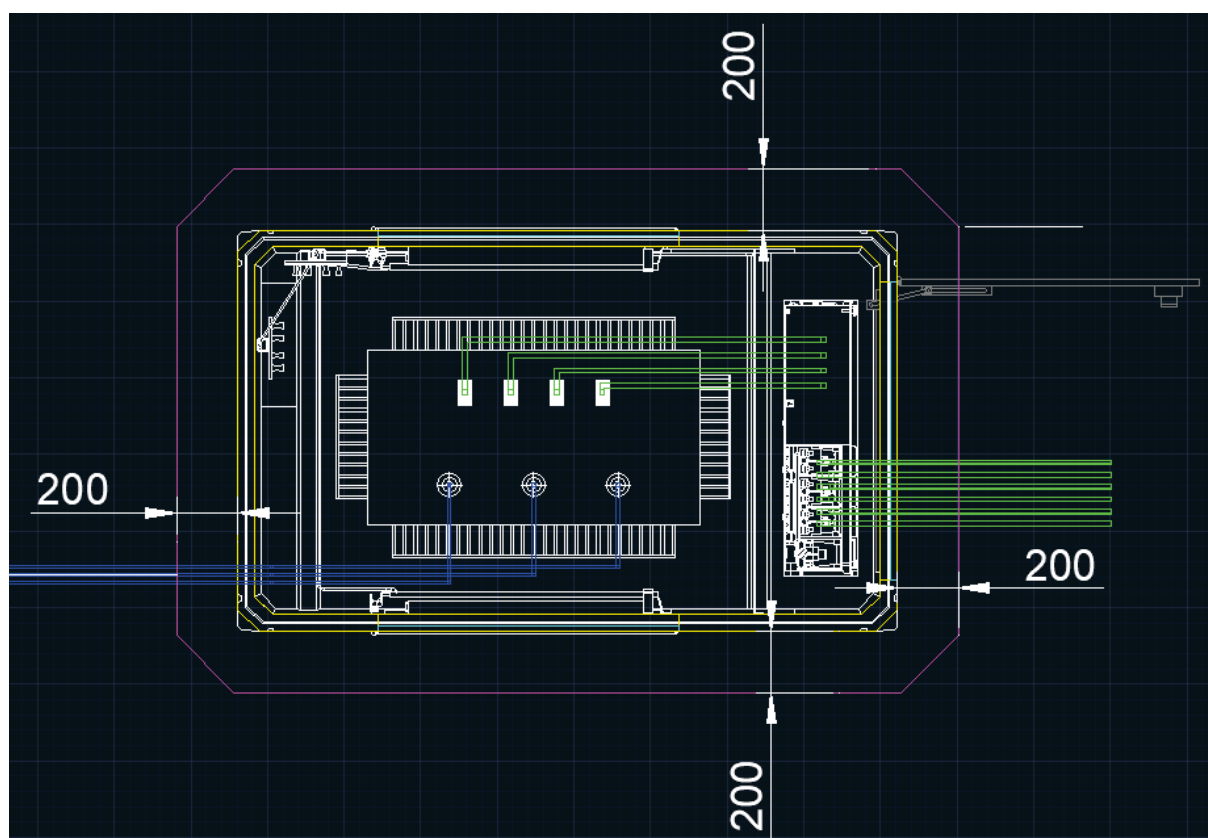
Vista en planta de la instalación (1T [Rural]) (cotas en mm).
